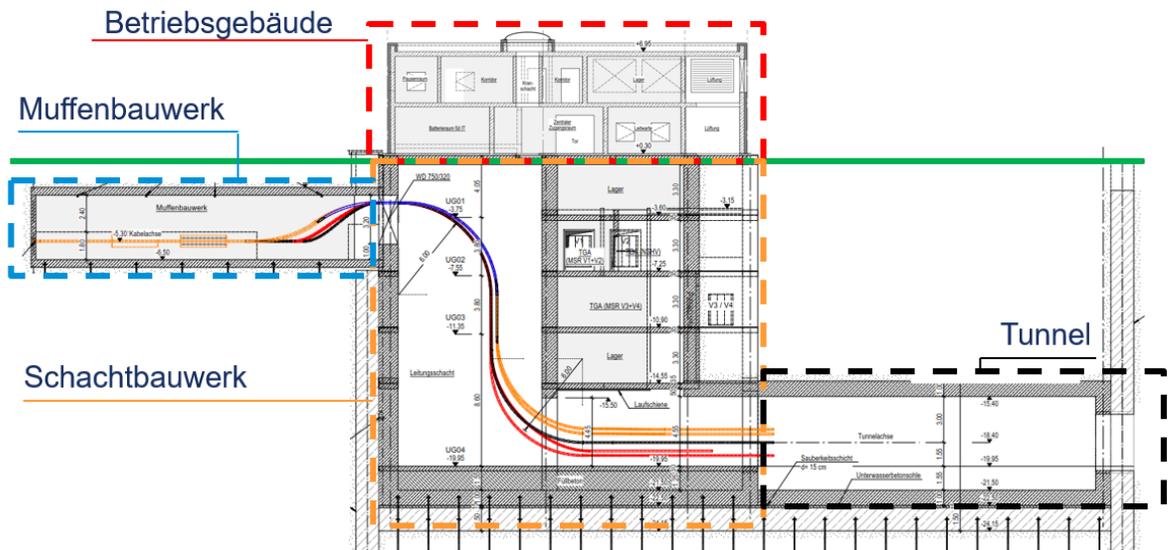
Bauwerkquerschnitt: Rot eingefasst liegt oberirdisch das Betriebsgebäude des ElbX, darunter liegend orange eingefasst das Schachtbauwerk mit Anschluss an das Muffenbauwerk mit blauer und dem Tunnel mit schwarzer Umrandung. Die Oberfläche ist grün dargestellt. (In Anlehnung an: ElbX Planungsgemeinschaft 2019a)³
